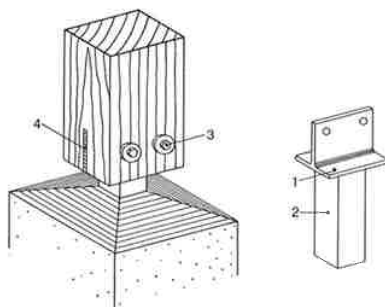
Pied de poteau sur socle de béton: 1. profilé métallique soudé en T ou demi-I; patin encastré dans le bois de bout; 2. tube carré; 3. boulon; 4. entaille garnie d'un mastic souple ou n'allant pas de bout en bout.
